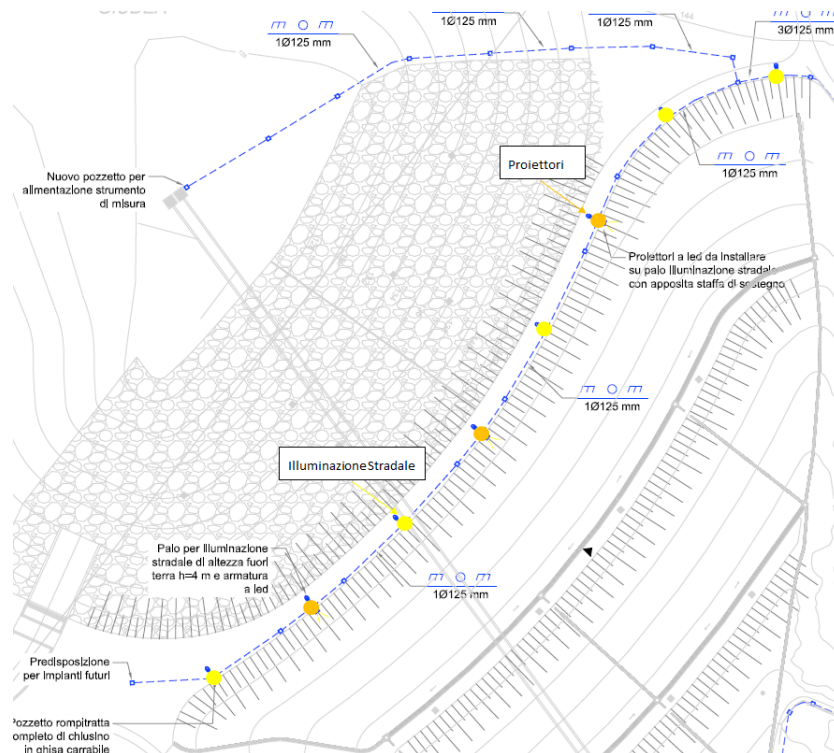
Planimetria ubicazione punti di illuminazione sul coronamento
